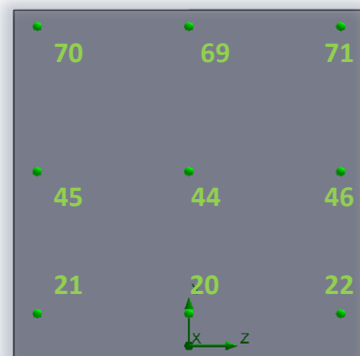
Planta del edificio con los correspondientes Point Goals
